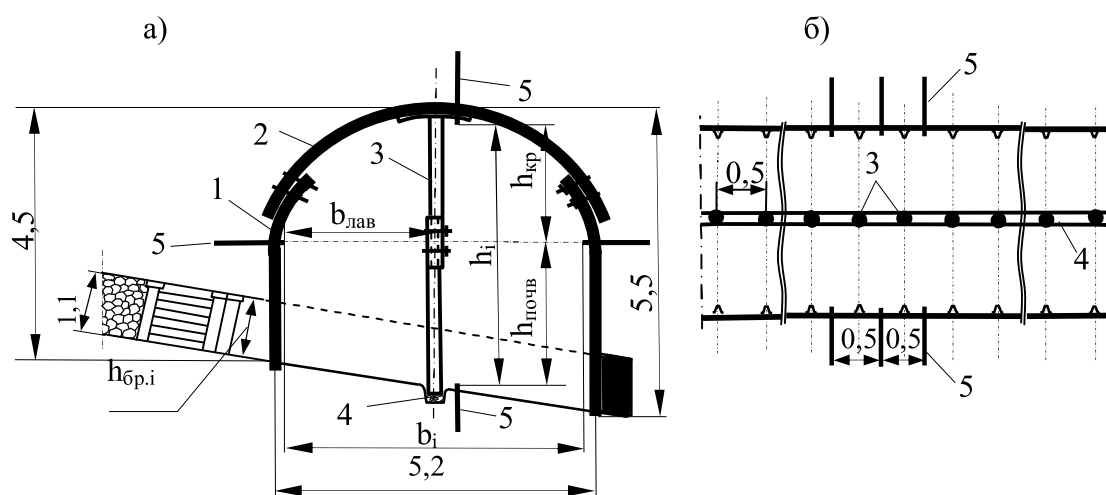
Конструкция упорно-лежневой крепи усиления из спецпрофиля СВП-33 на 1-м экспериментальном участке: 1, 2 – соответственно стойка и верхняк комплекта арочной крепи; 2 – индивидуальная крепь усиления их отрезков СВП-33; 3 – деревянный лежень по почве выработки; 4 – контурные реперы
